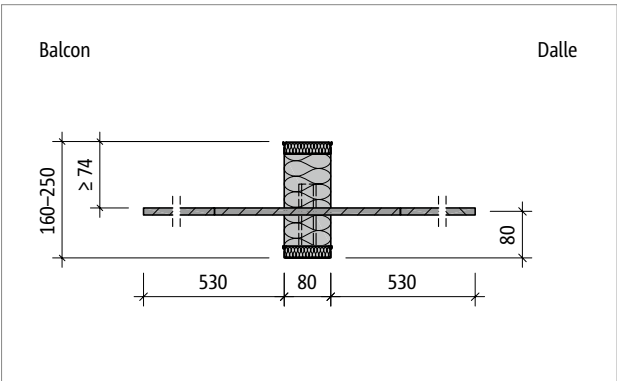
Schöck Isokorb® T Type H-NN2 : Coupe du produit
